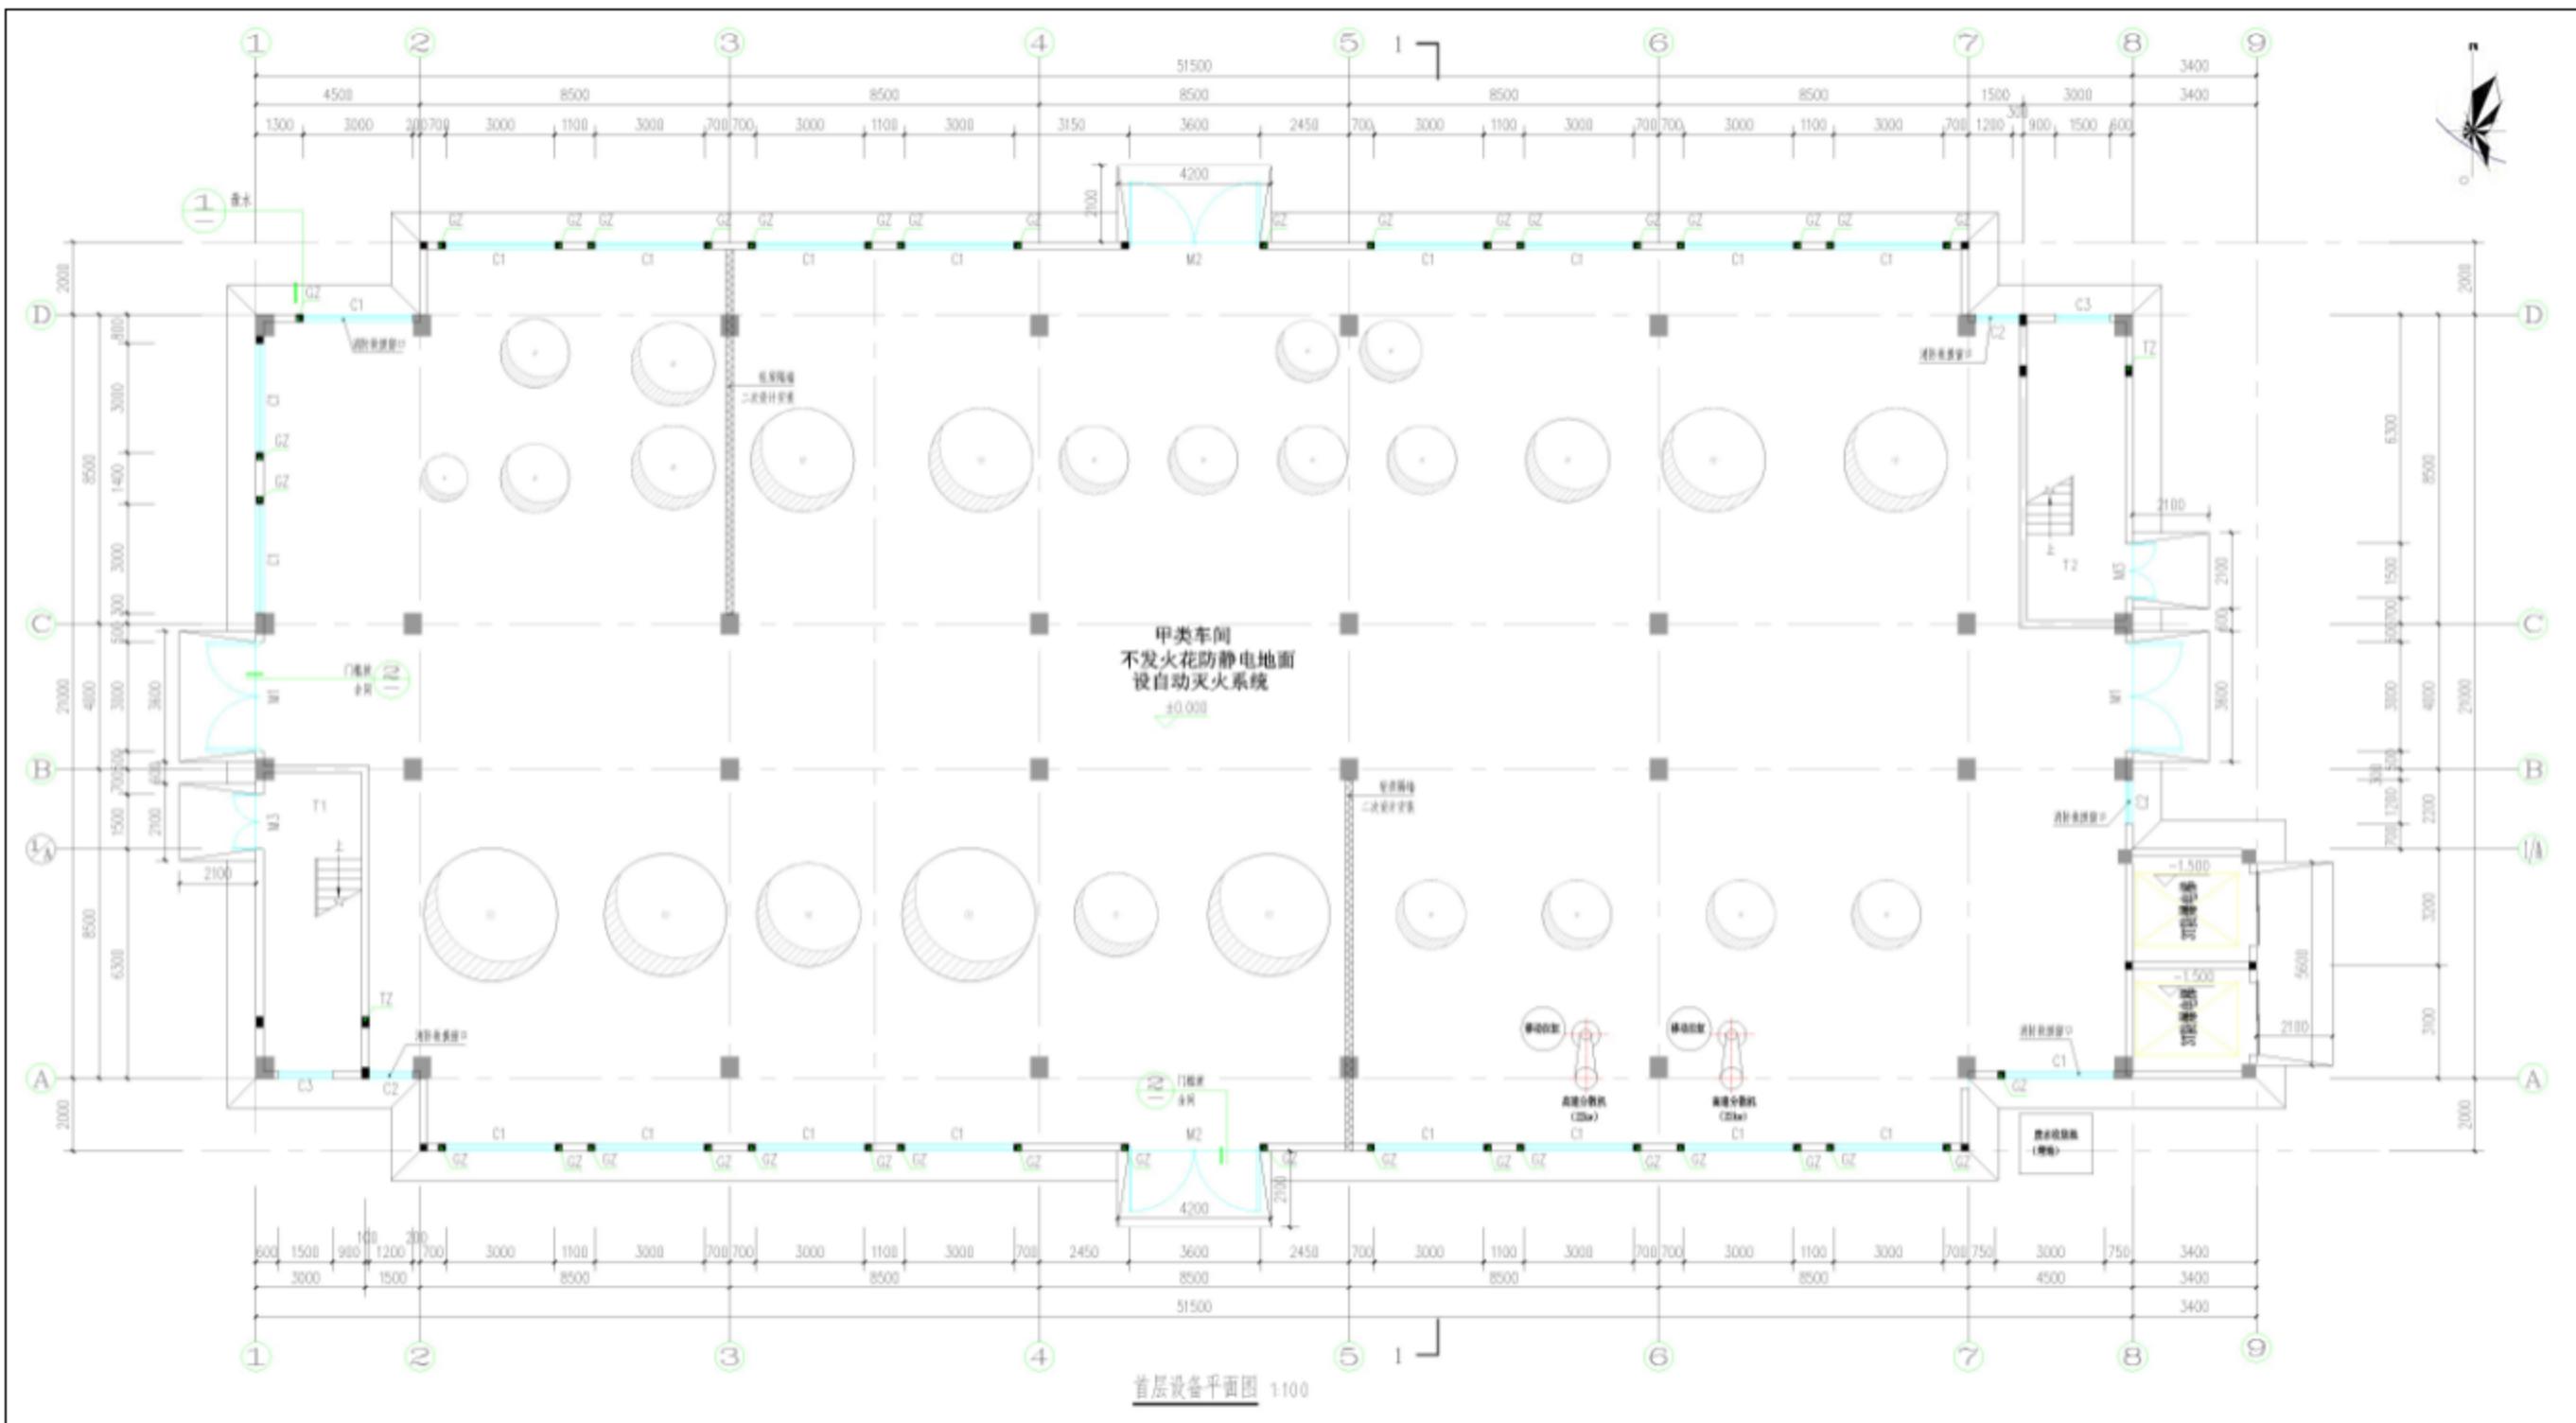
甲类车间C1层平面布置图(比例尺1:100)
